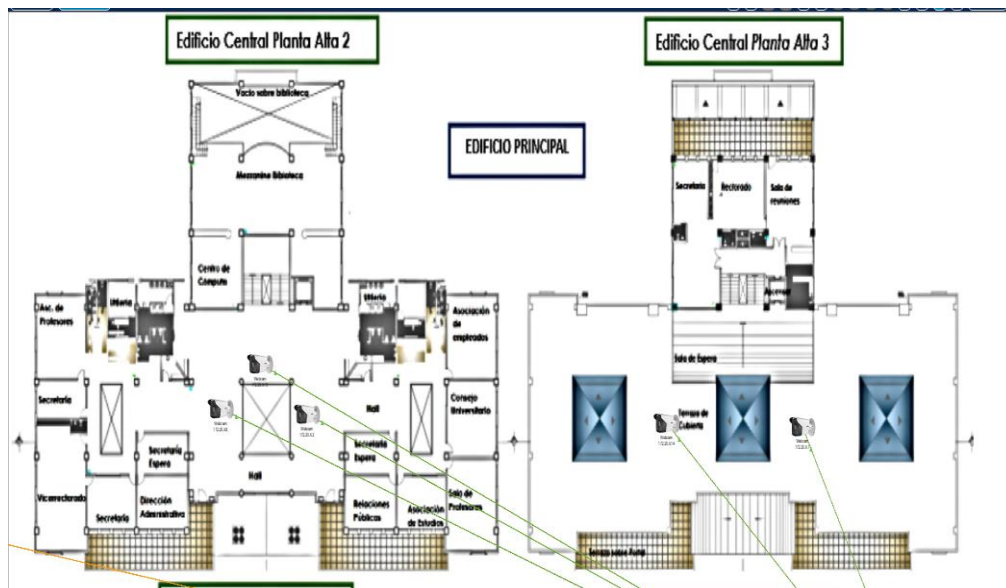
Cámaras en el Edificio Principal Planta alta 2 y Planta alta 3
